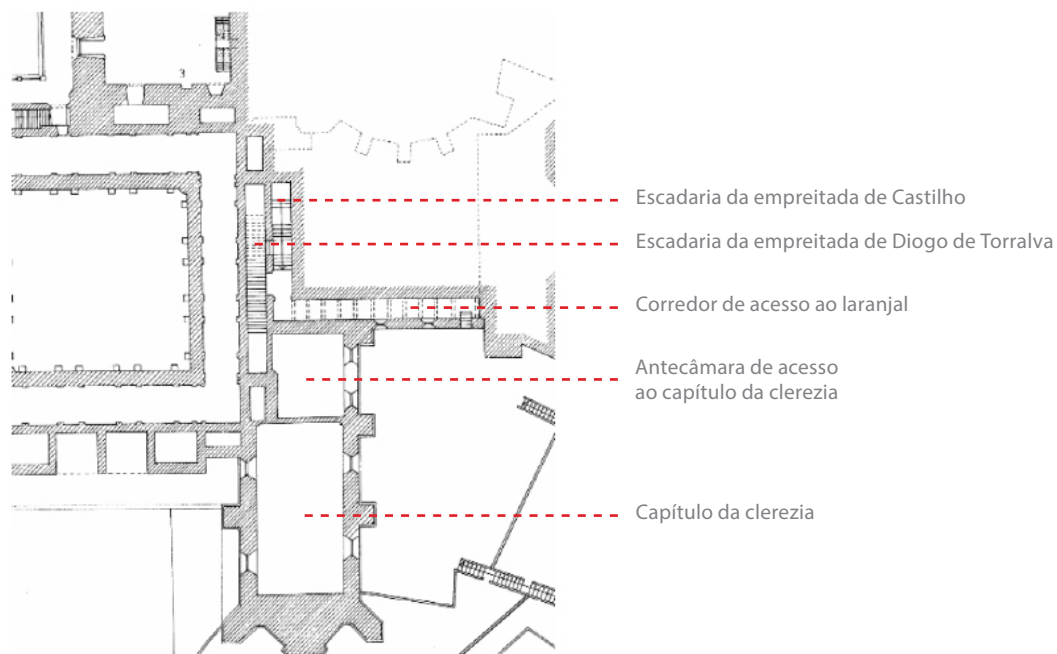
Planta com a indicação do corredor do laranjal que intersectou a ligação ao capítulo da clerezia.
